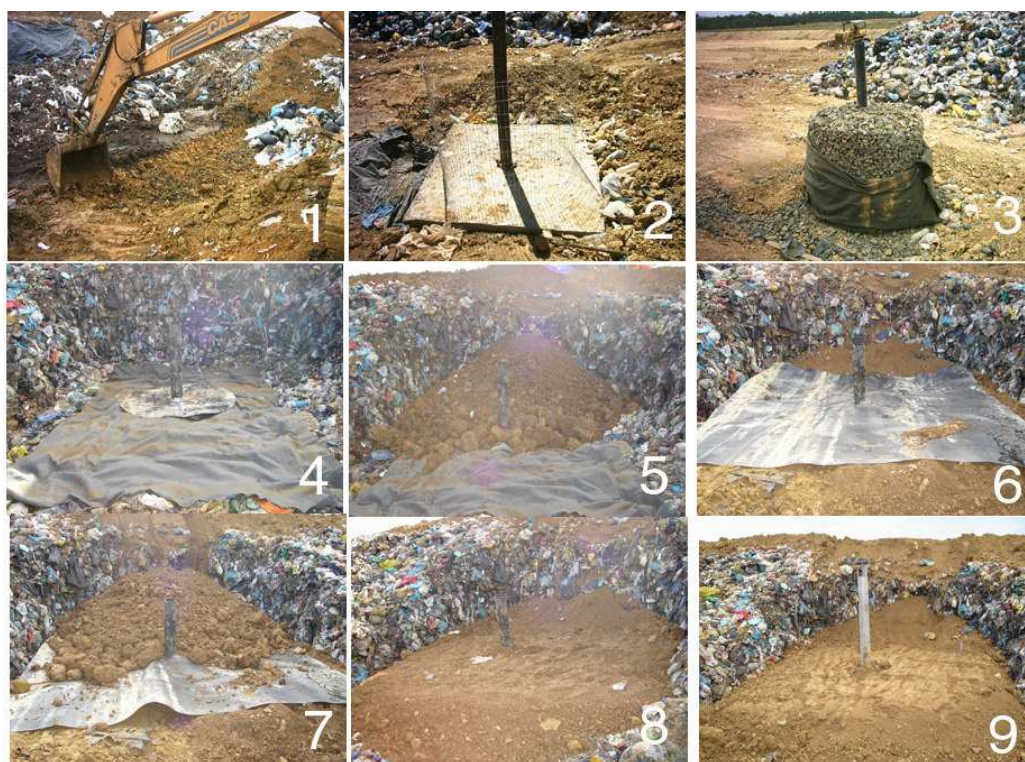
Etapas de instalação dos drenos de biogás (Fonte:MANGILI, 2006).
